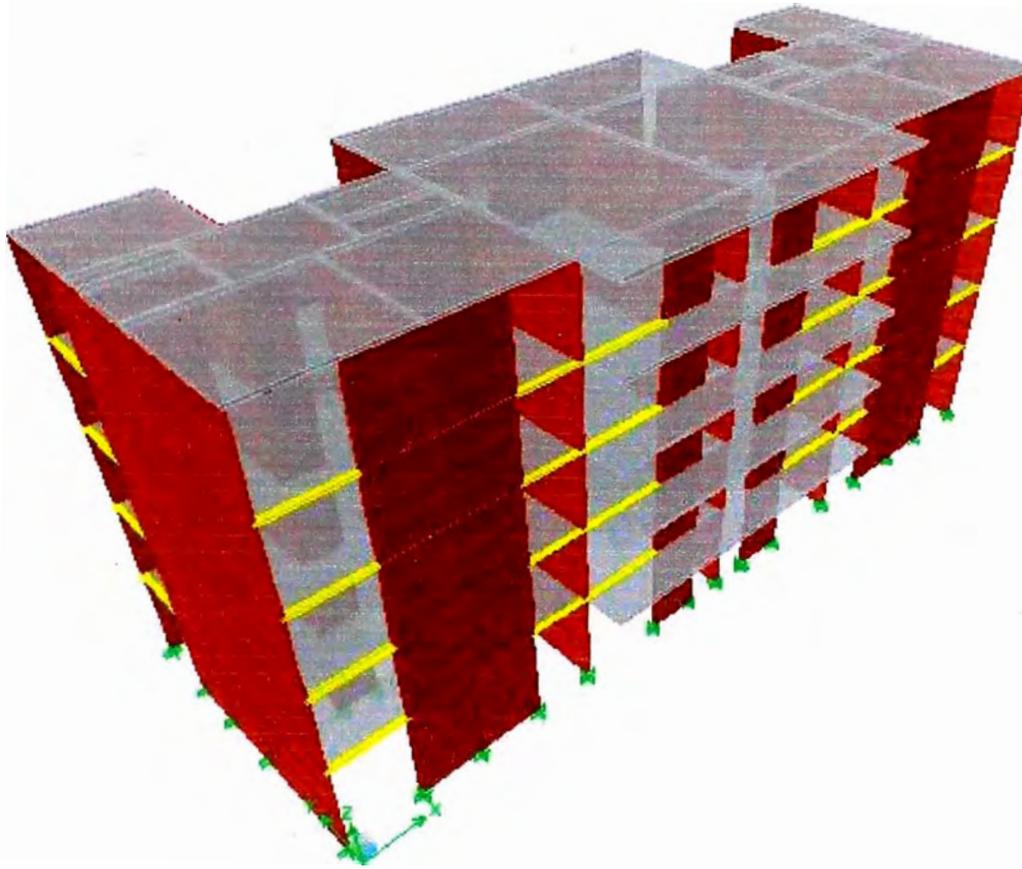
Vista en 3D de la Edificación (Etabs)
